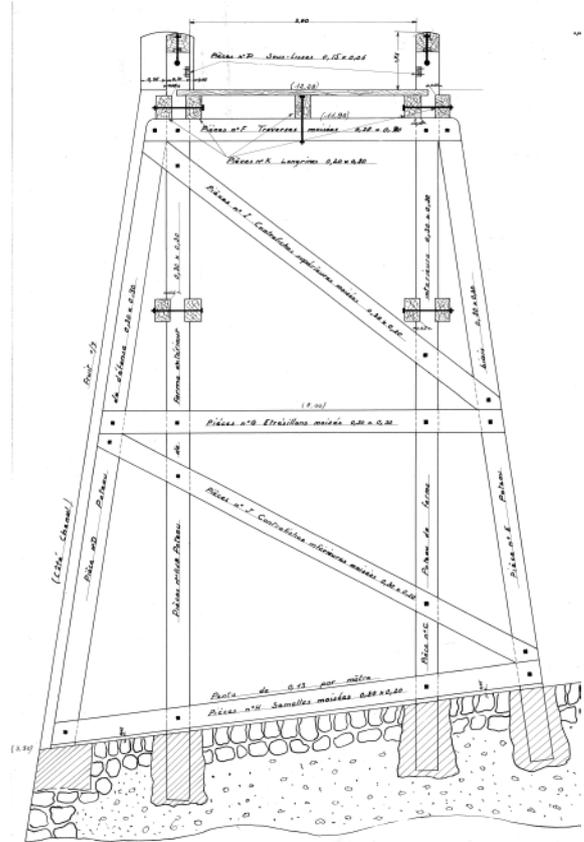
Coupe type – estacade existante reconstruite en Azobé (1938)
